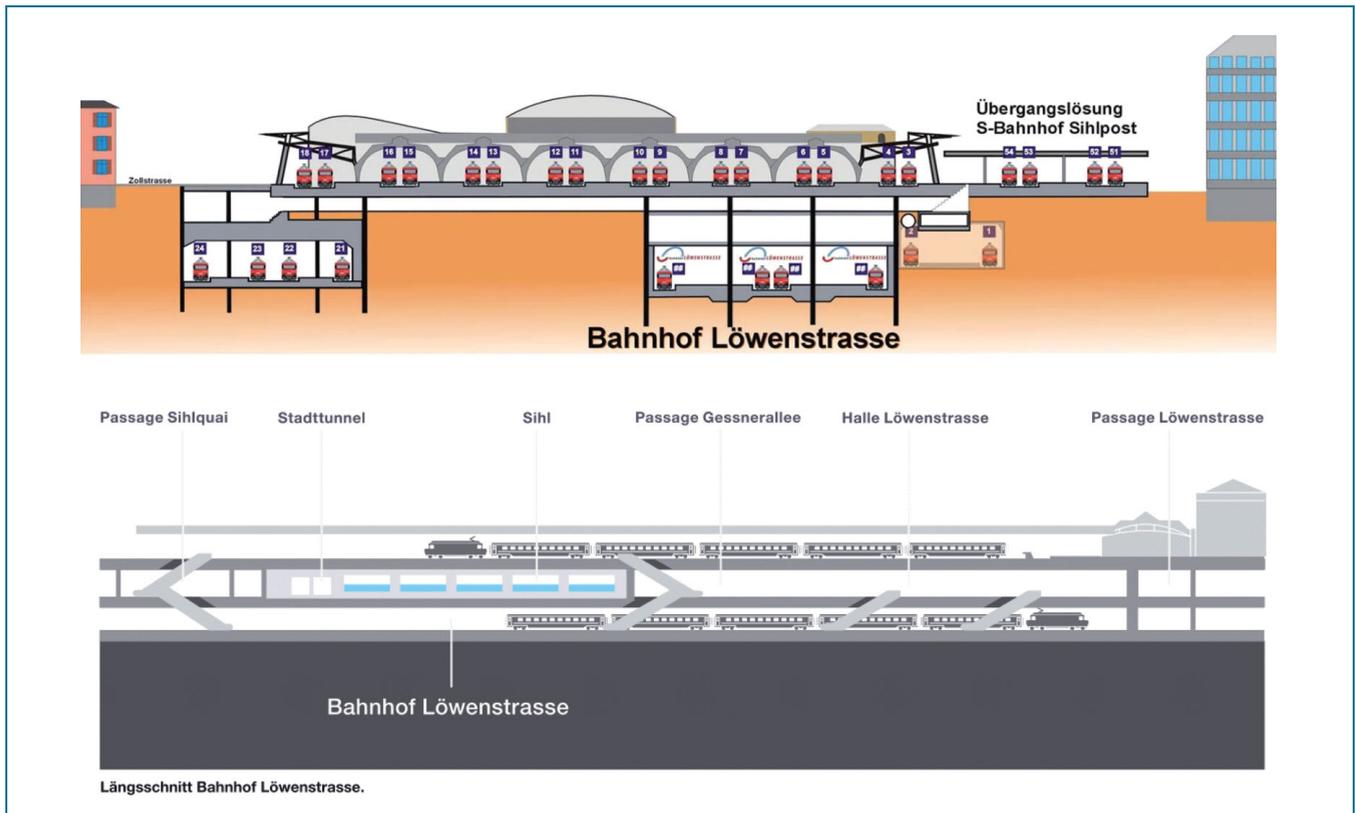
Längs- und Querprofil zum Abschnitt 2 („Bahnhof Löwenstrasse“) [1]
